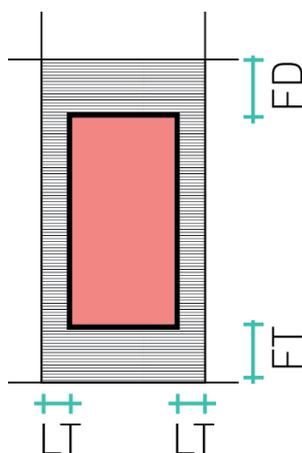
Aplicação da lei vigente - Perspectiva aérea.
